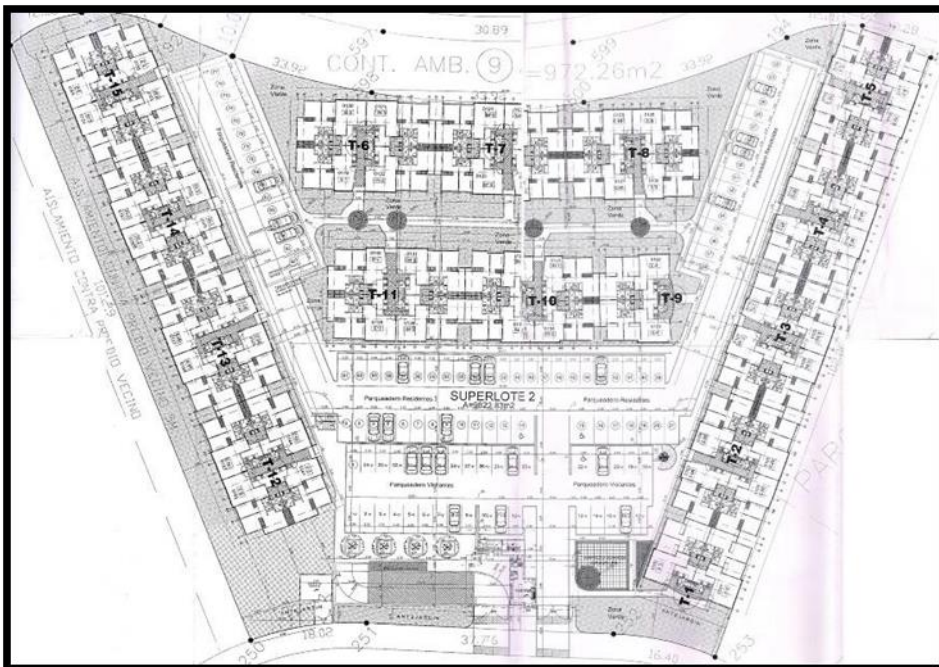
Planta Arquitectónica Primer Piso, Zona de Parqueaderos (Cubierta Sótano) y Torres.
